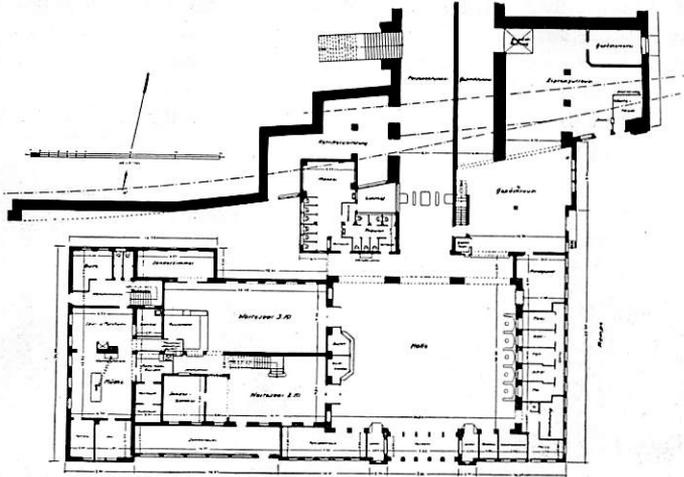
Erdgeschoßgrundriß Empfangsgebäude Meissen.
